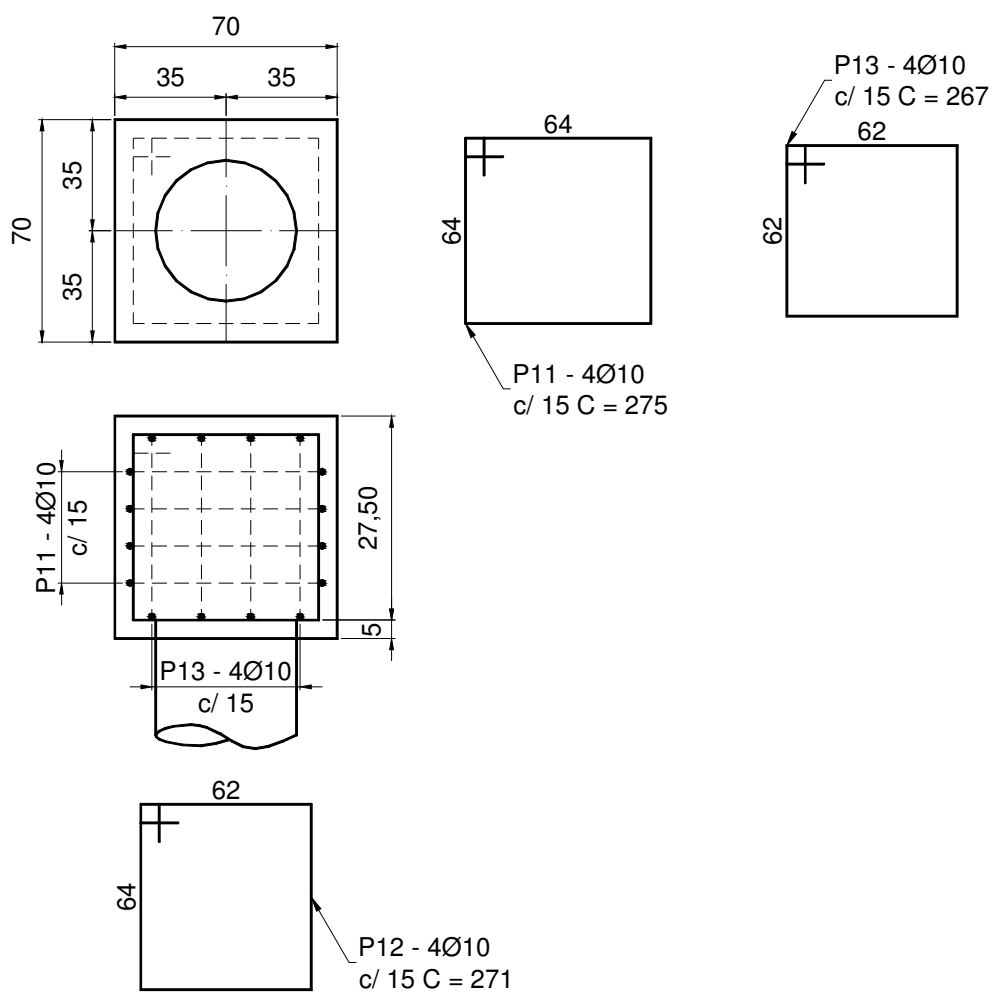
Exemplo de detalhamento das armaduras para o bloco de transição.
